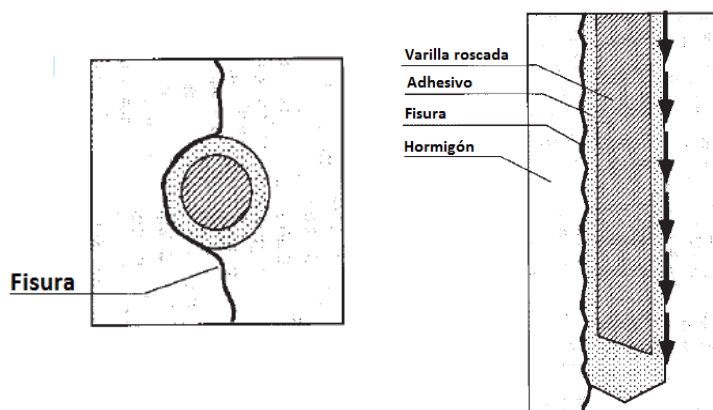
Transmisión de cargas al material base en hormigón fisurado.
